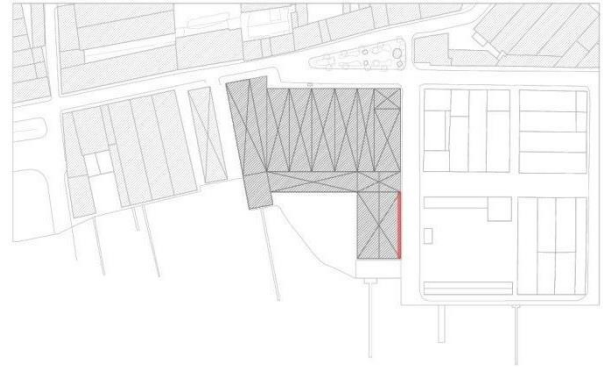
Reconstituição da planta de 1916, segundo anexo IV.
